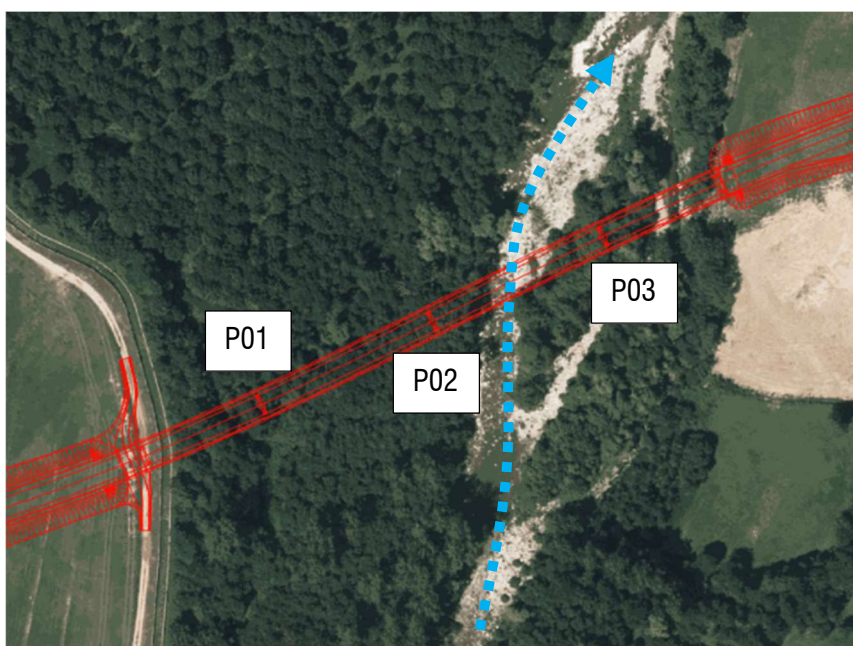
Inquadramento planimetrico dell'attraversamento stradale sul Torrente Ellero, ortofoto AGEA 2018; (P01, P02, P03: pile del viadotto in progetto)
